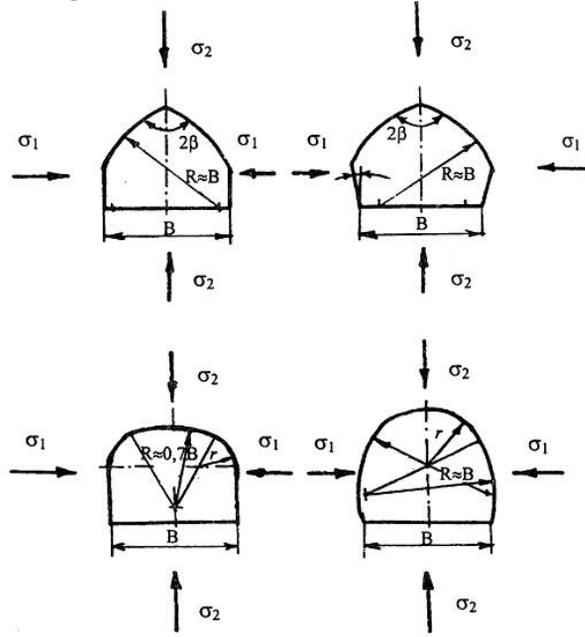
Рациональные формы поперечных сечений выработок при вертикальном и горизонтальном направлении главных нормальных напряжений: а – прямоугольно-шатровое; б – трапециевидно – шатровое; с – прямоугольно – сводчатое; d – подковообразное
